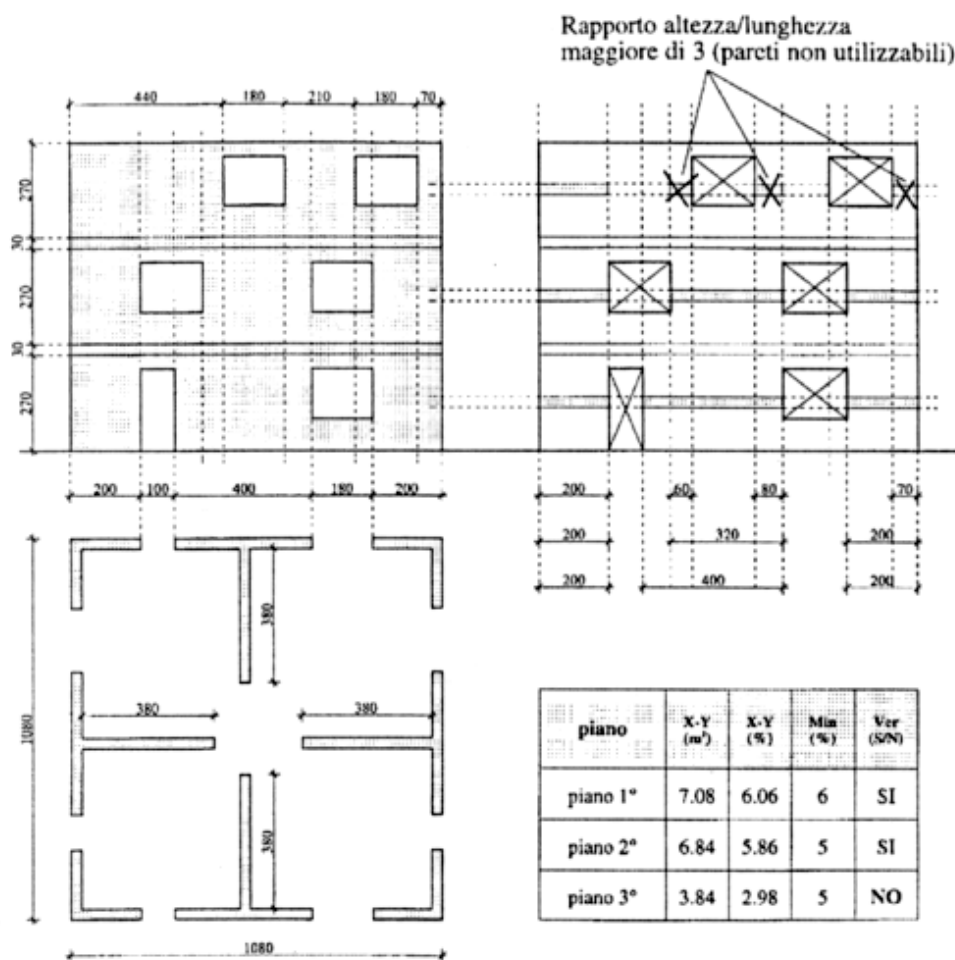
Esempio di determinazione delle aree delle murature reagenti ( 13).
